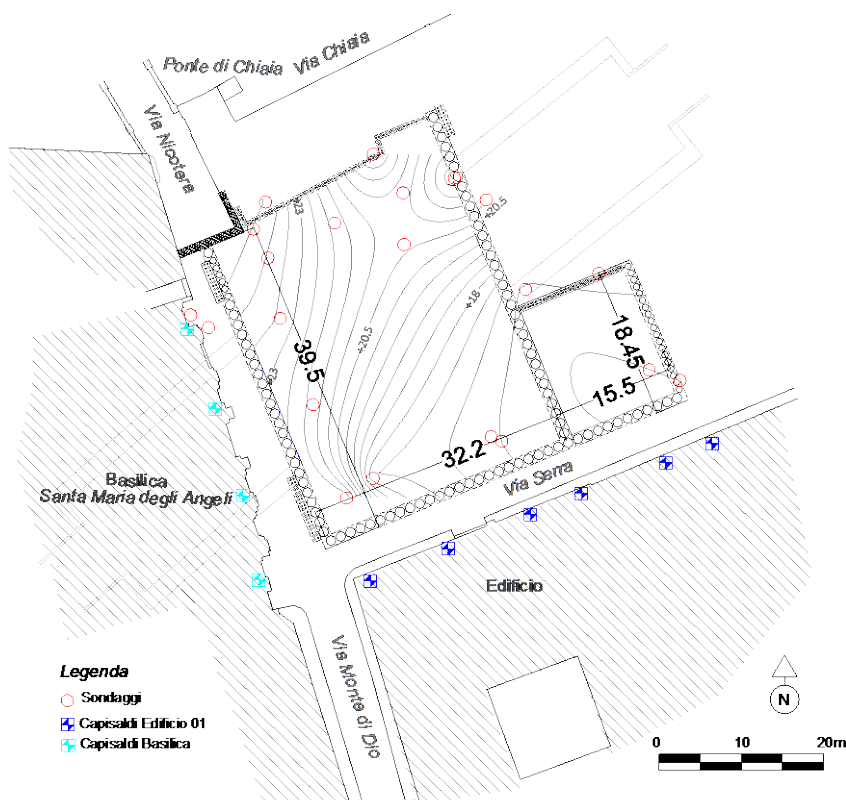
Pianta della stazione Chiaia con planimetria della zona.
